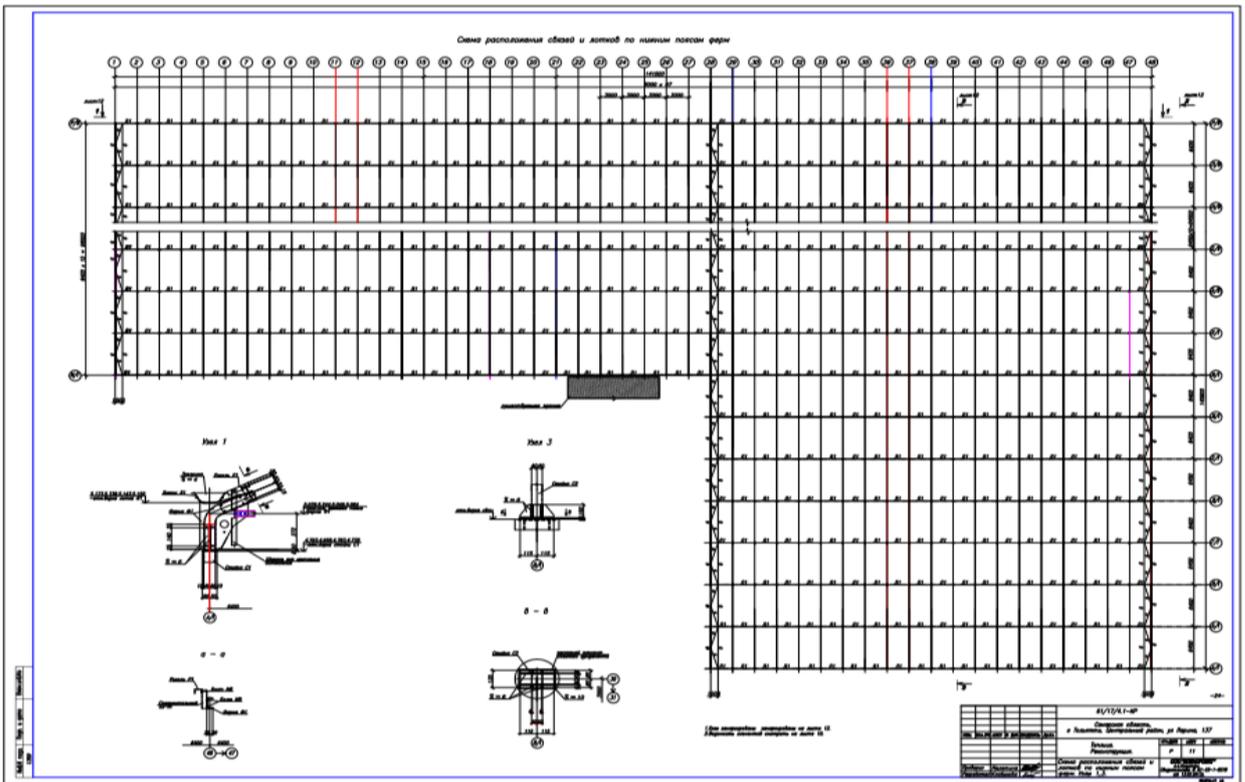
Схема расположения связей по нижним поясам ферм
